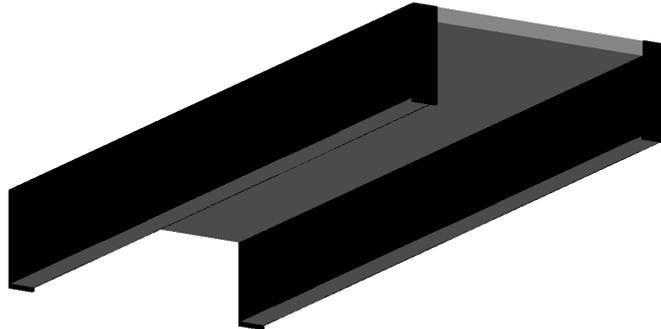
Сталезалізобетонна плита перекриття з армуванням ребер вертикальними сталевими листами
